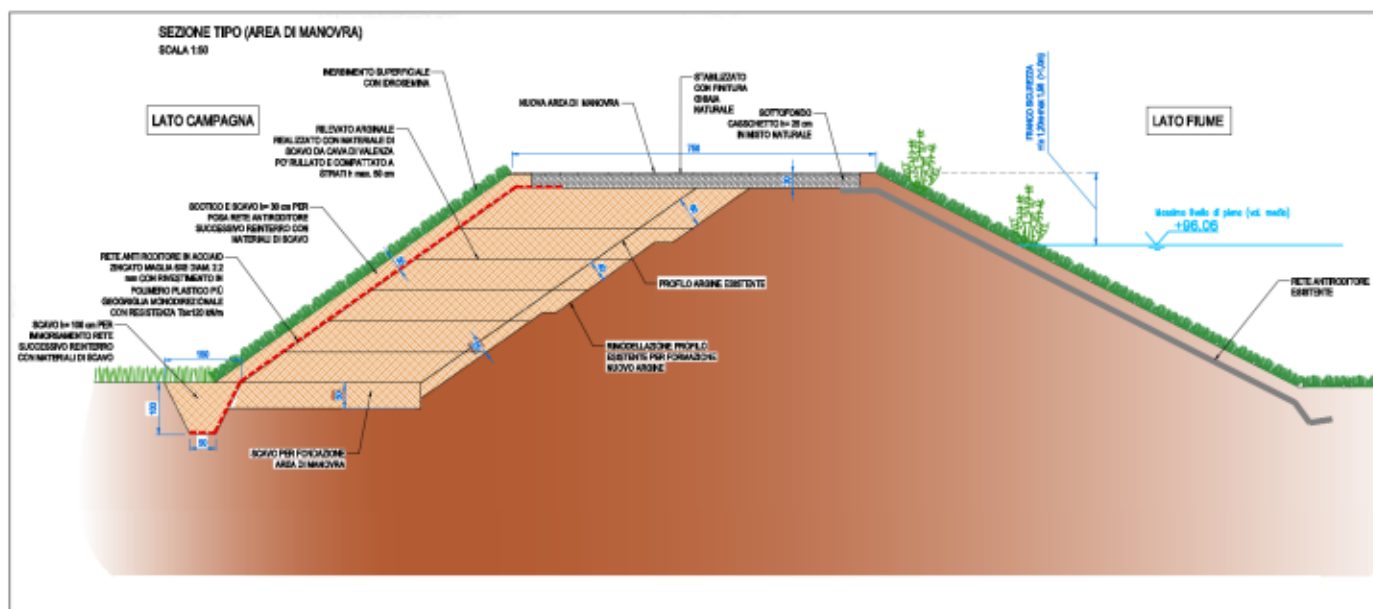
bis - Stralcio progettuale Sezione tipo nuova piazzola.
